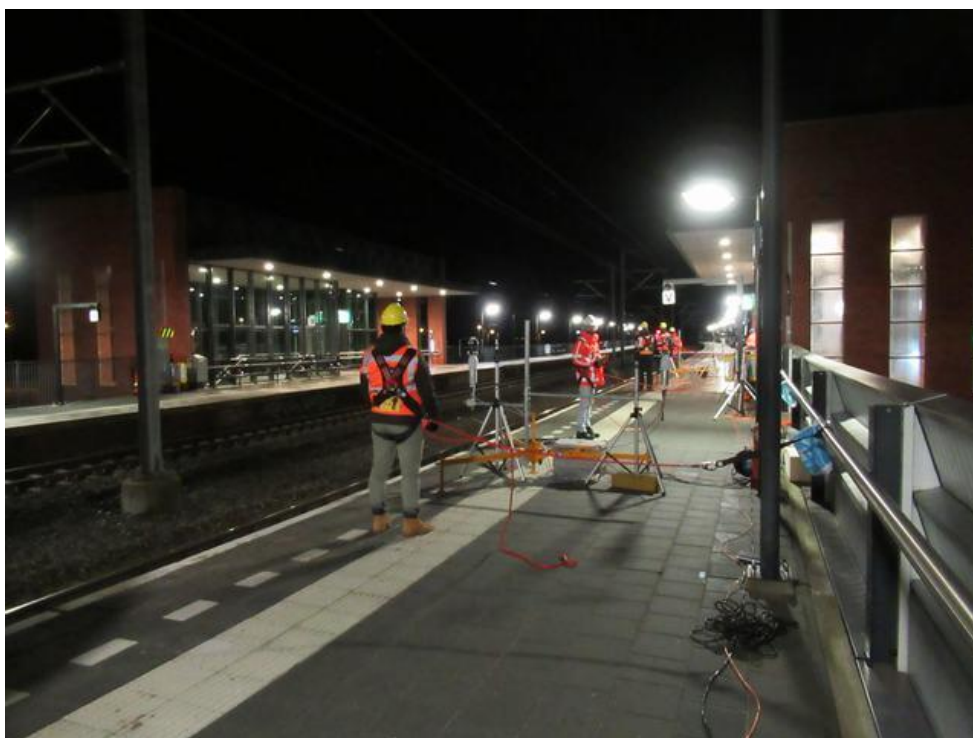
Meetdoorsnede met gedeeltelijk gesloten achterzijde en opstelling proefpersonen.
